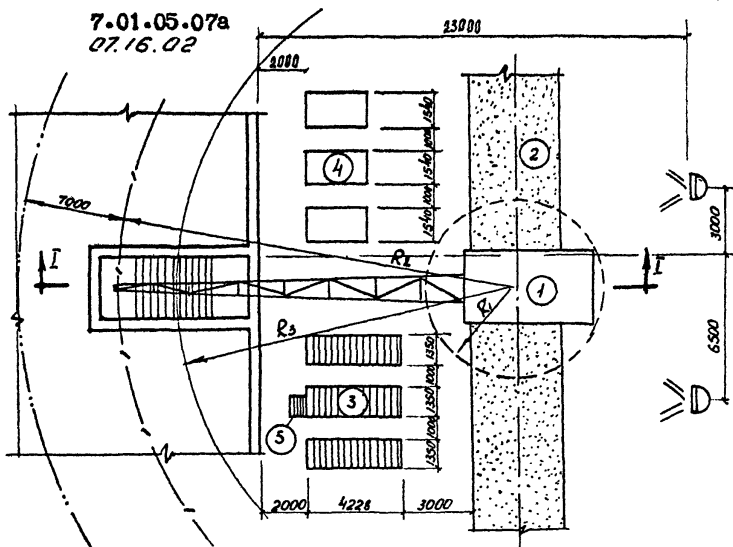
Схема монтажа лестничных маршей и площадок гусеничным краном.
